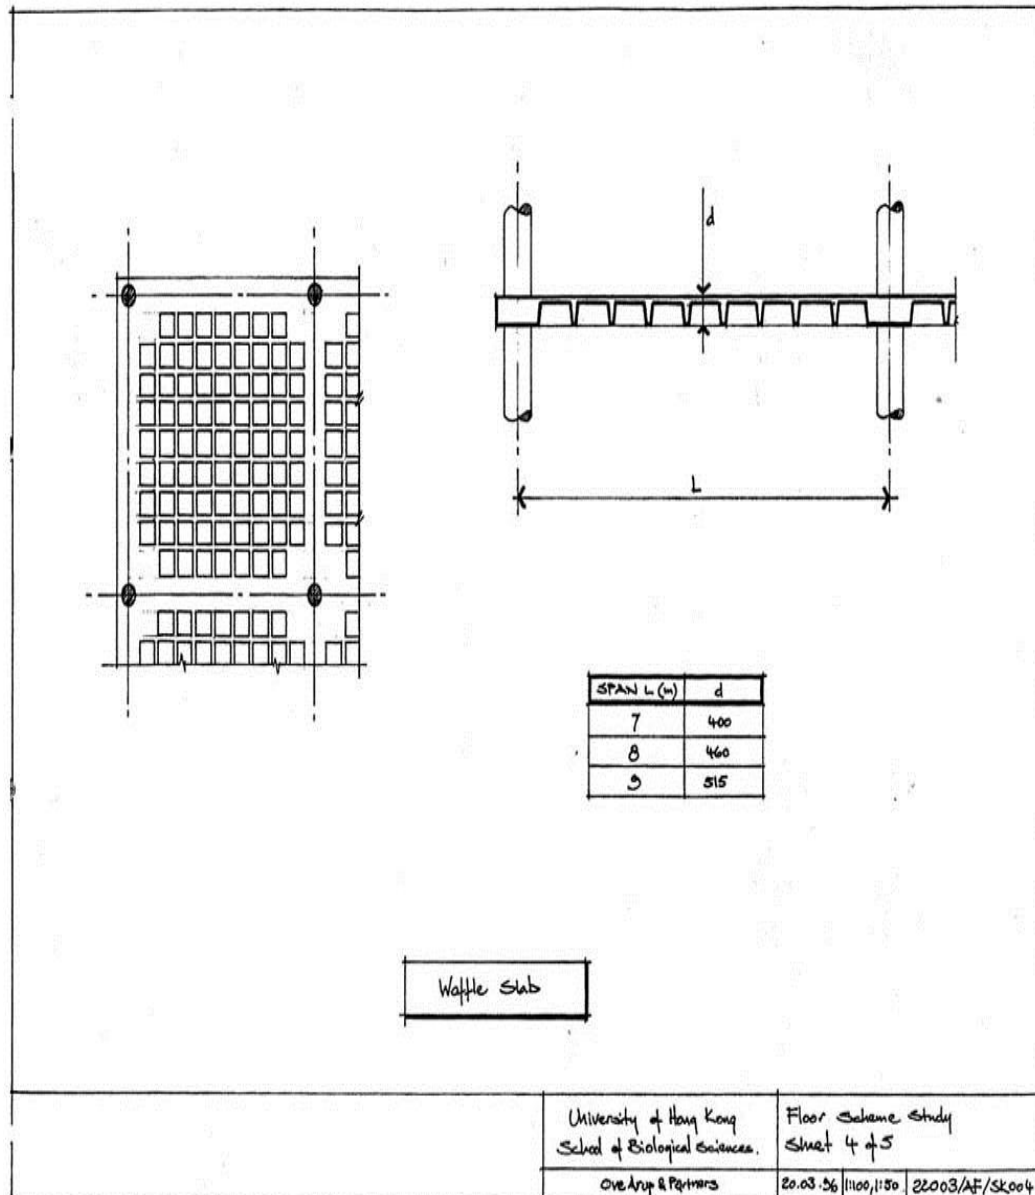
Penerapan Pelat Lantai Dua Arah Dengan Balok
